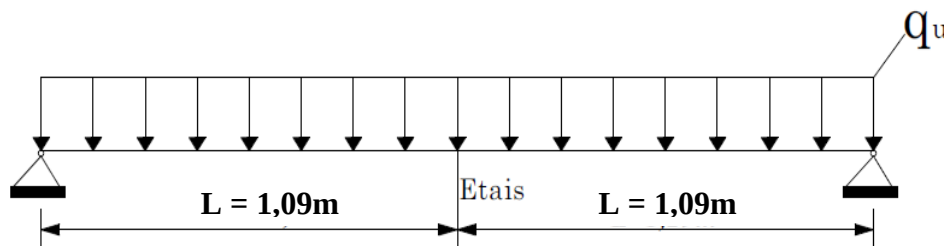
Schéma statique d'un plancher collaborant en phase de chantier
